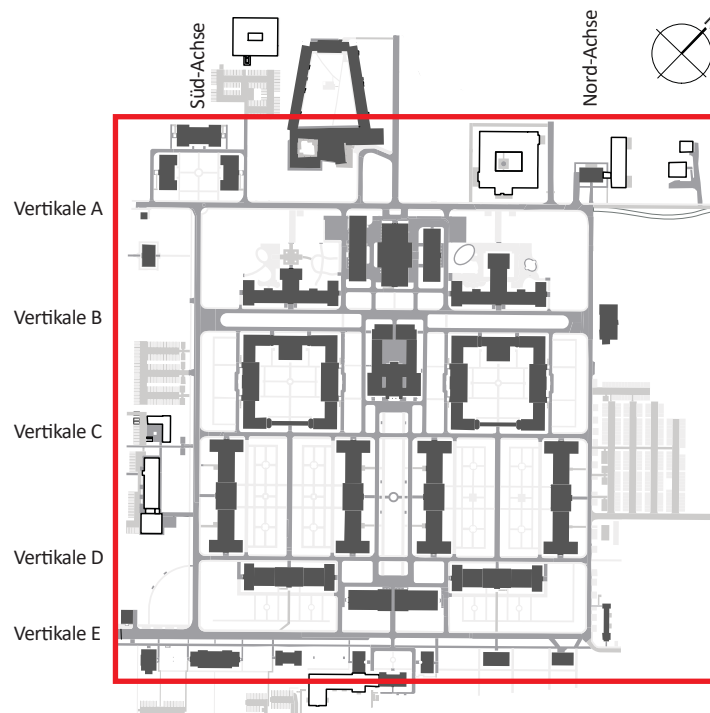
| LHQ 2016, Lageplan mit Straßenbezeichnungen
